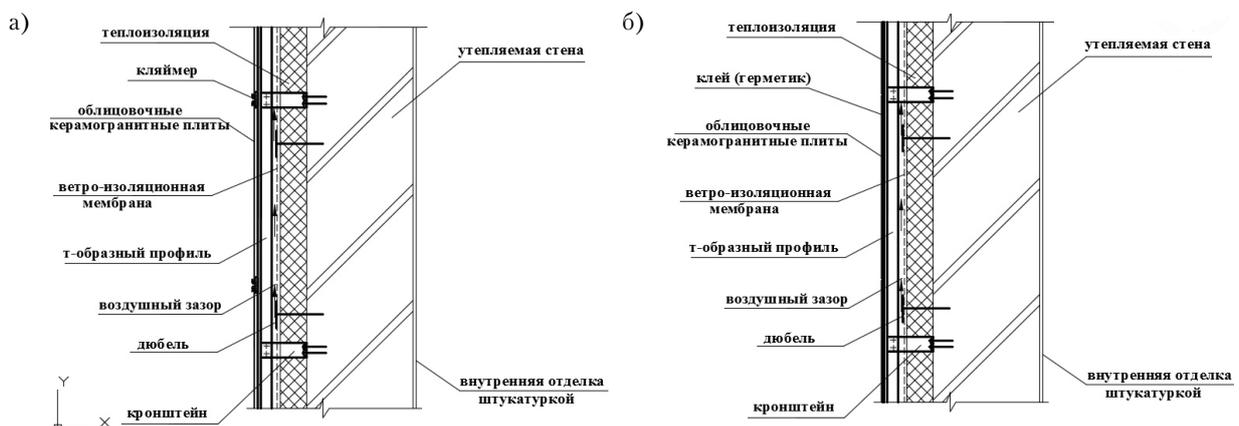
Навесной вентилируемый фасад с облицовкой керамогранитными плитами: а) видимое крепление на кляймерах; б) скрытое клеевое крепление.
